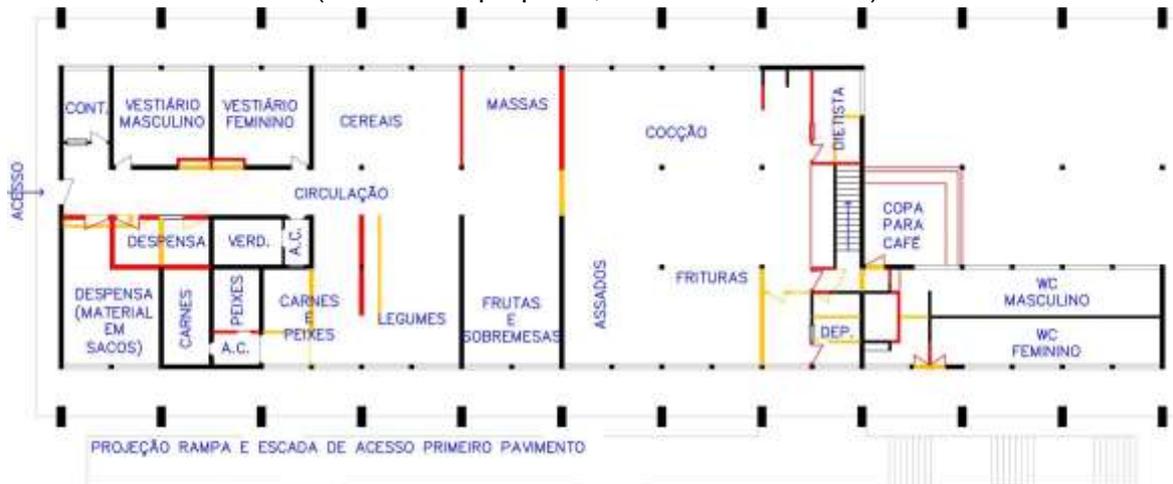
Planta baixa pavimento superior - 1957 - percurso usuários
